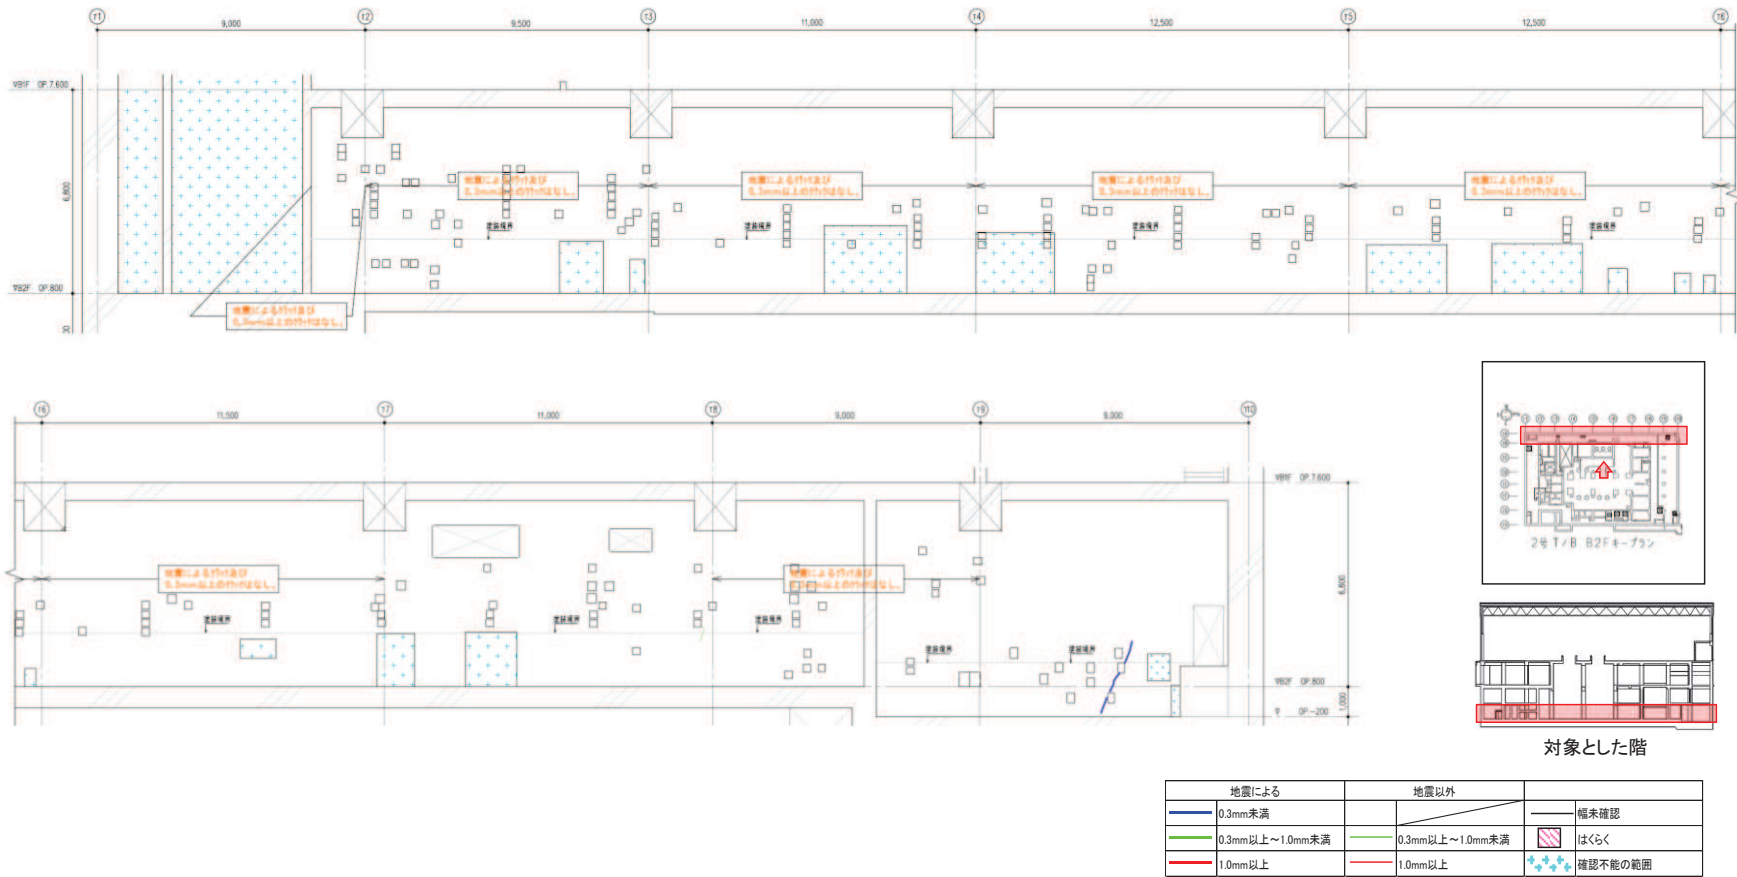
タービン建屋のひび割れ分布 耐震壁 (10) 地下 2 階 TA 通り
